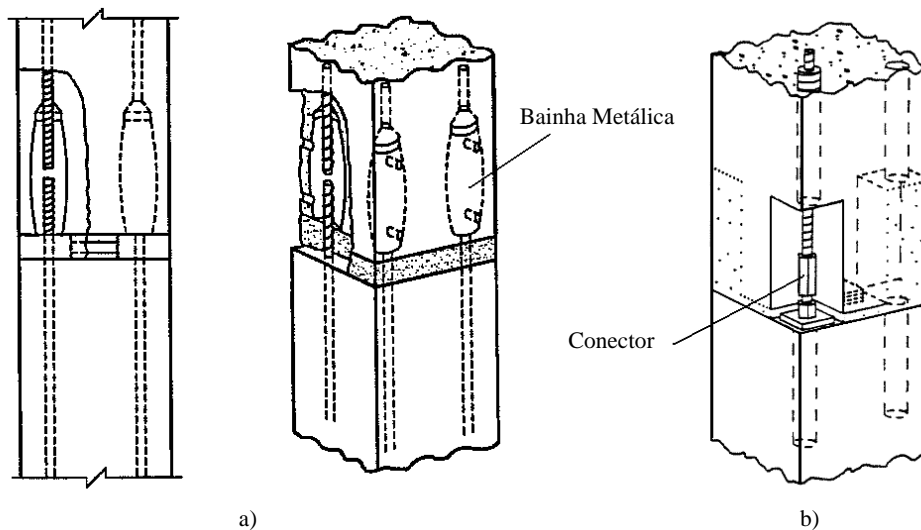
Ligação pilar - pilar com amarração por emenda: a) através de bainha metálica, b) através de um acoplador, a) adaptado de [30], b) adaptado de [6]
